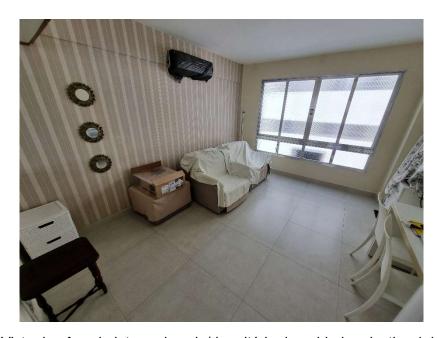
Vista do cômodo integrado sala/dormitório da unidade privativa 1.110, unidade similar ao imóvel avaliando, apresentando as seguintes características construtivas: piso em revestimento cerâmico; paredes revestidas parte em papel de parede, parte em pintura látex PVA sobre massa corrida; teto em pintura látex PVA sobre massa corrida; esquadrias da janela em alumínio.
